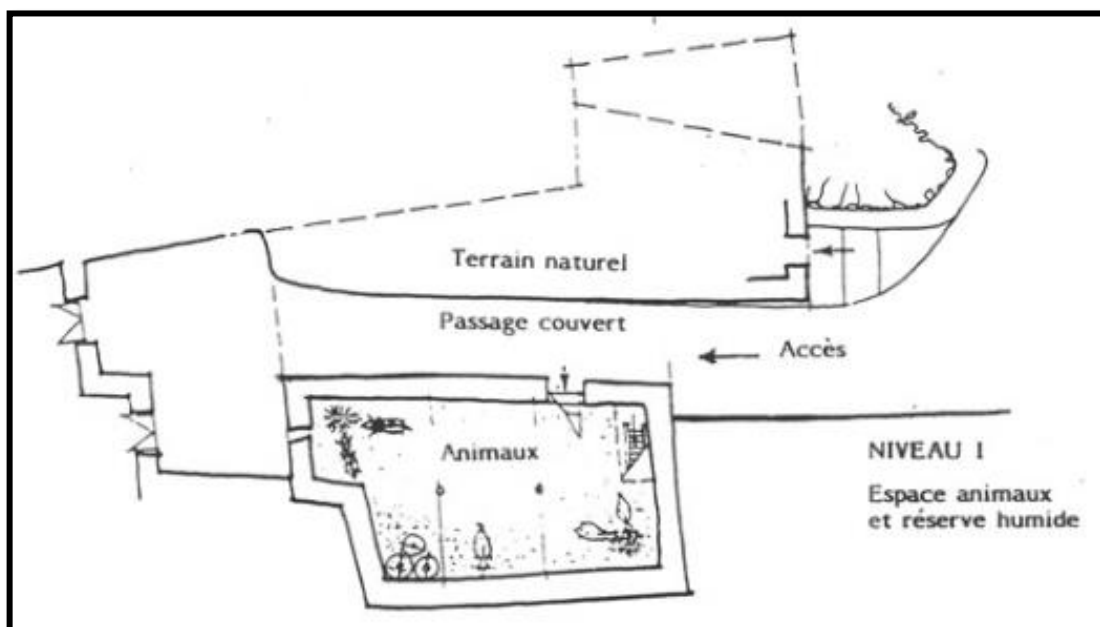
Plan De 1^{er} niveau d'une maison Chaoui.
